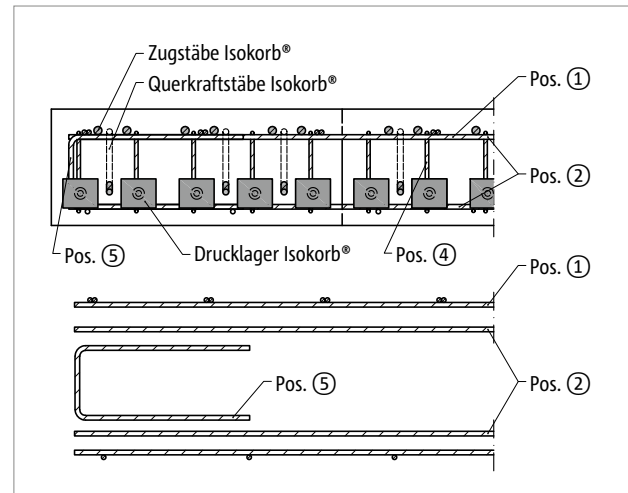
Schöck Isokorb® XT Typ KP-M11: Bauseitige Bewehrung balkenseitig im Schnitt A-A; Pos. 5 = konstruktive Randeinfassung am freien Rand
